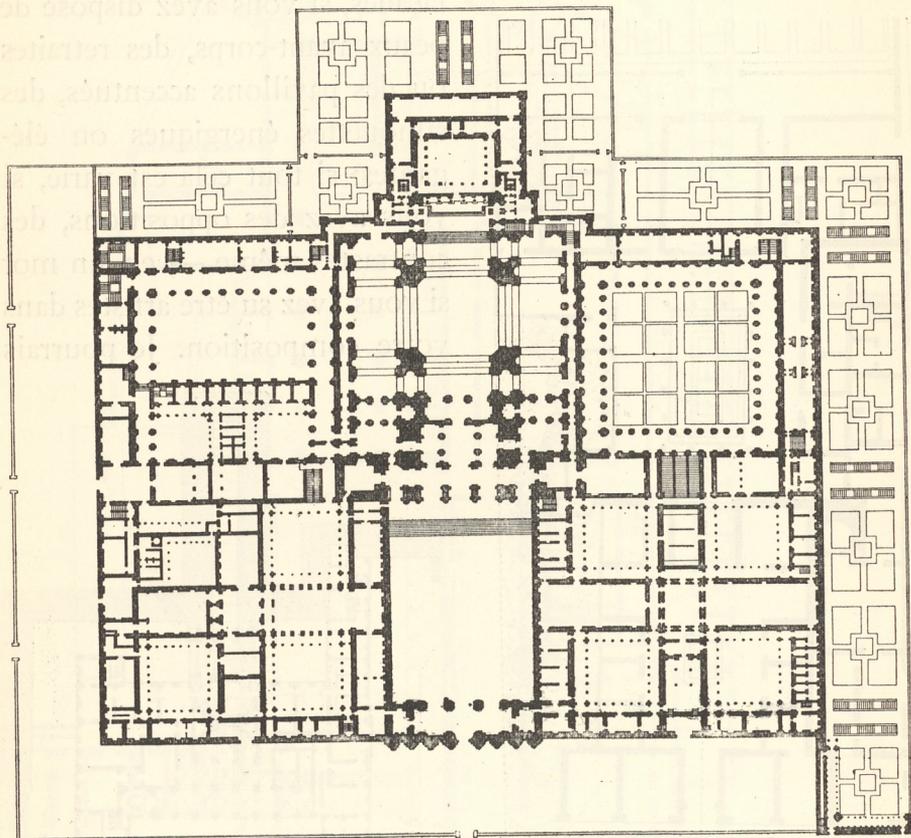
Plan de l'Escorial. Rez-de-chaussée.
